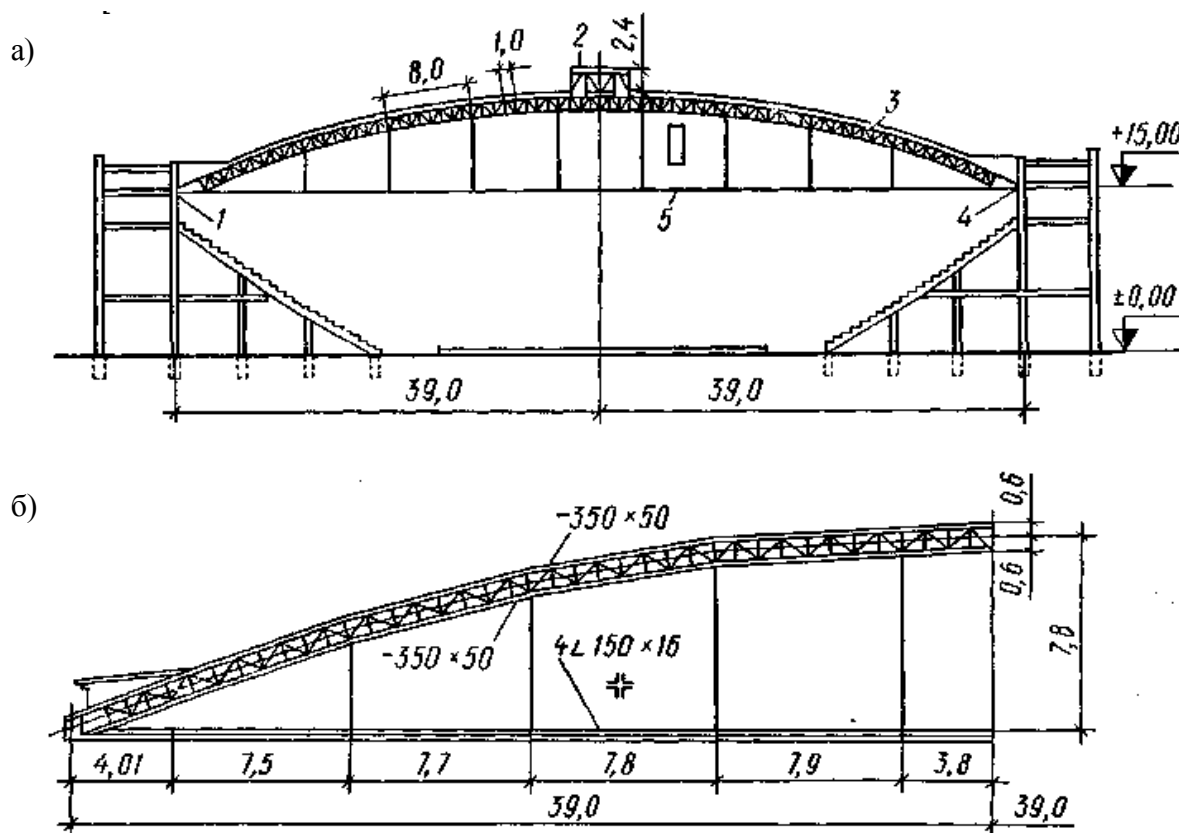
Конструкция арочного покрытия стальными арками с затяжкой Дворца спорта в Лужниках:
